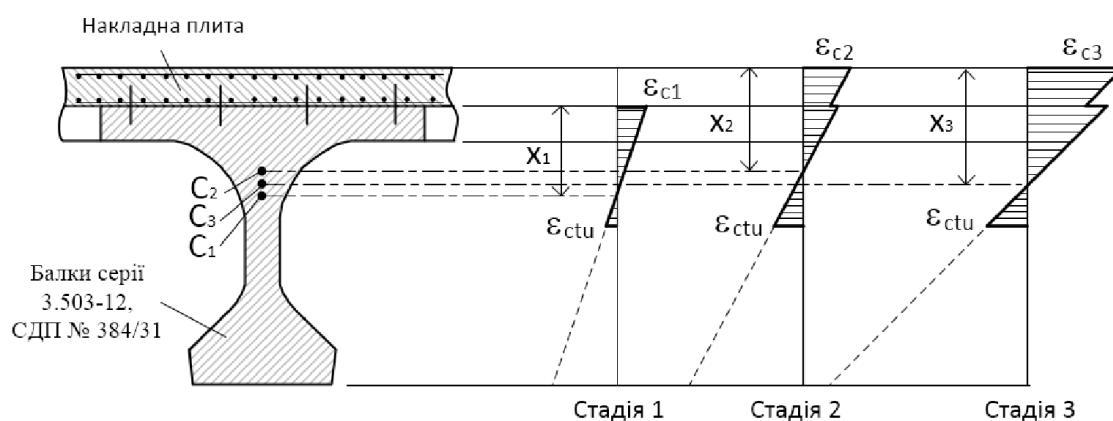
Стадії роботи прогонової будови при реконструкції за схемою влаштування накладної плити
